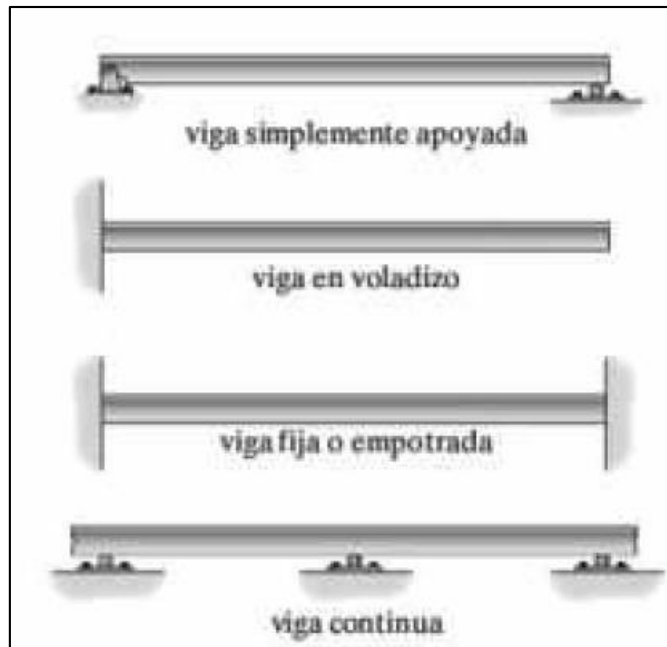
Clasificación de las vigas de acuerdo con sus apoyos.
